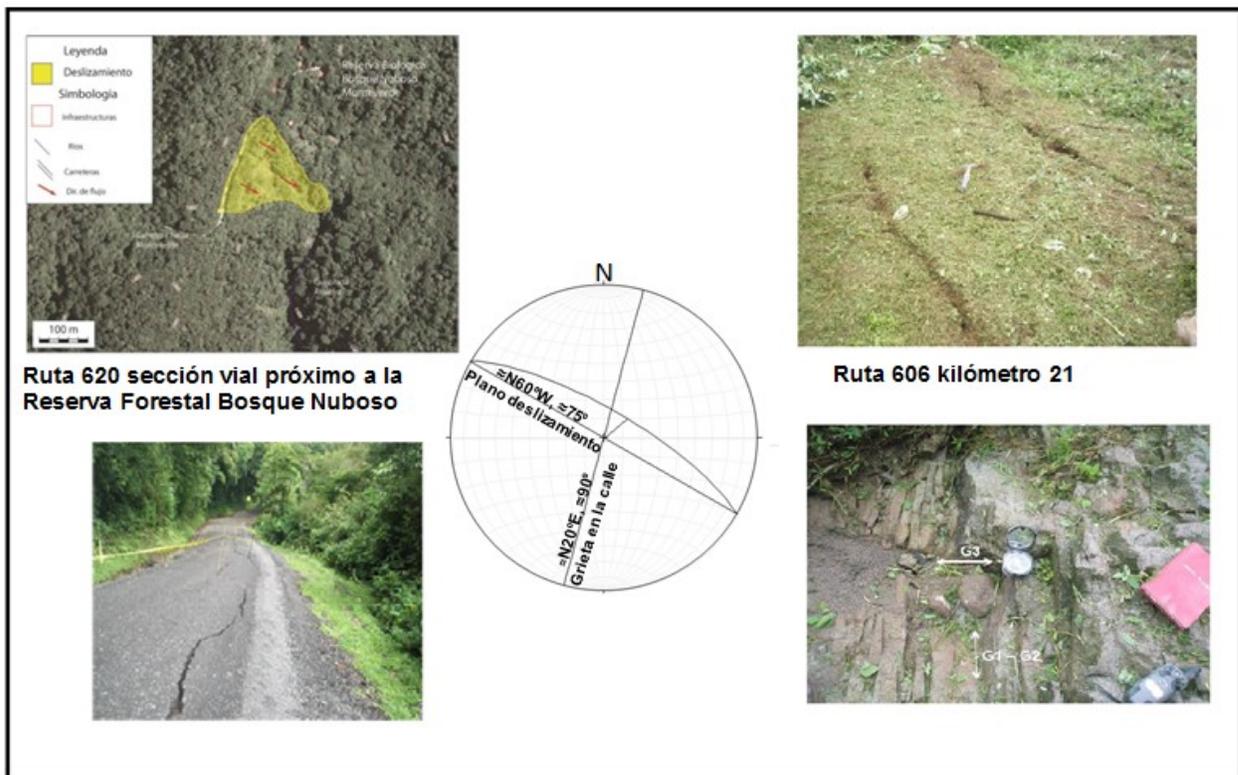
Proyección estereográfica del plano de las grietas y posible plano del deslizamiento en la ruta 620 y su relación con algunos de los planos medidos en el talud de deslizamiento de la ruta 606 kilómetro 21
